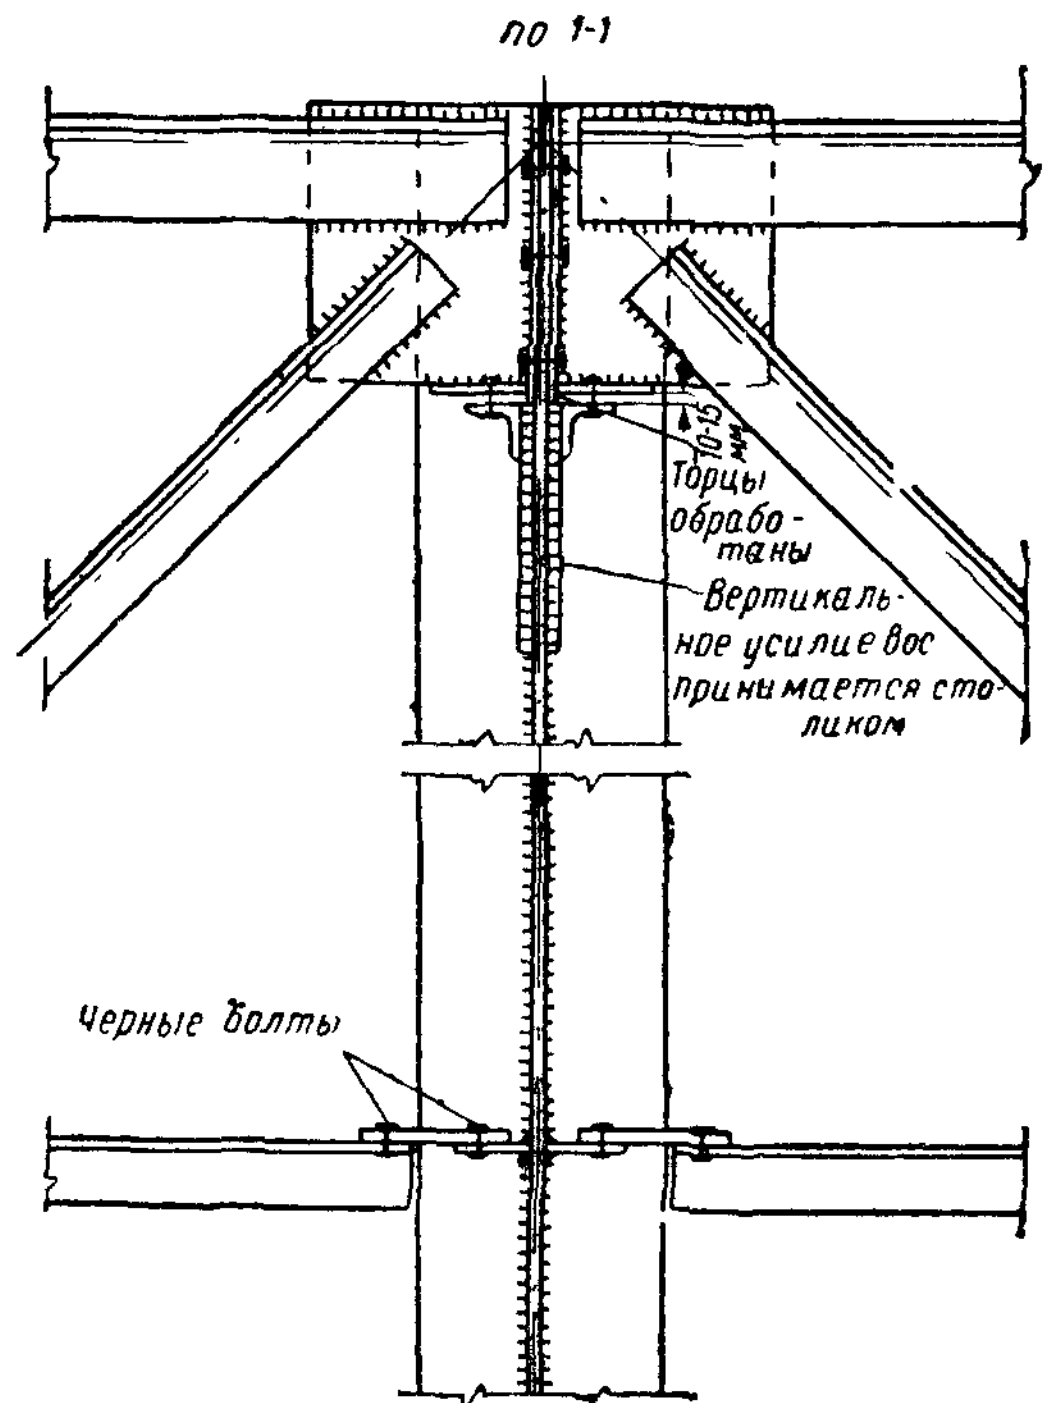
Прикрепление подстропильной фермы к стенке колонны
